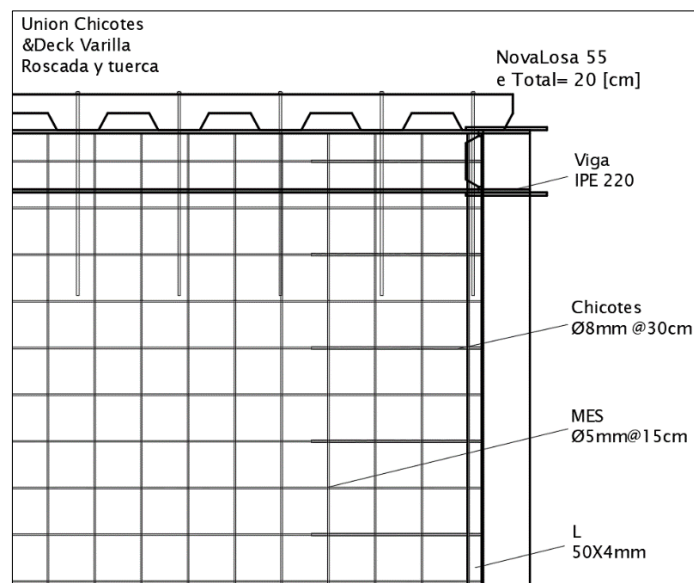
Detalle conexión superior malla electrosoldada-losa deck
